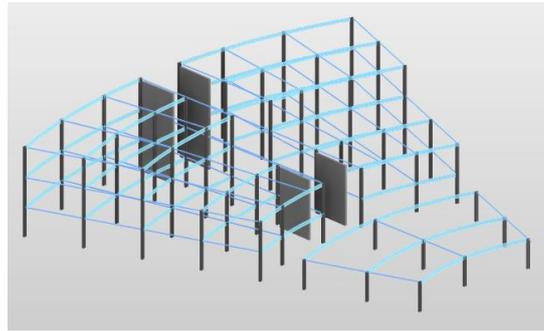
les éléments verticaux de la structure d'unité d'hébergement
